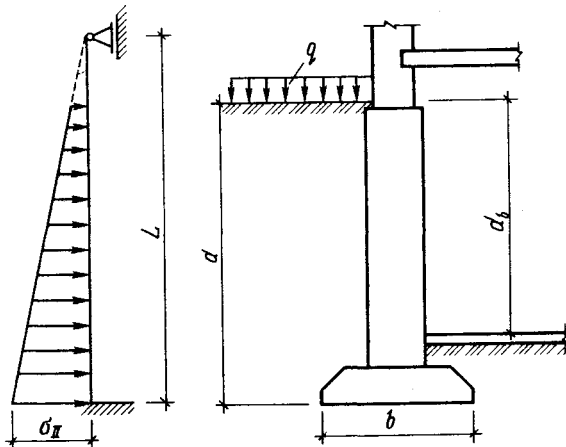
Расчетная схема к определению горизонтального давления на стену подвала
